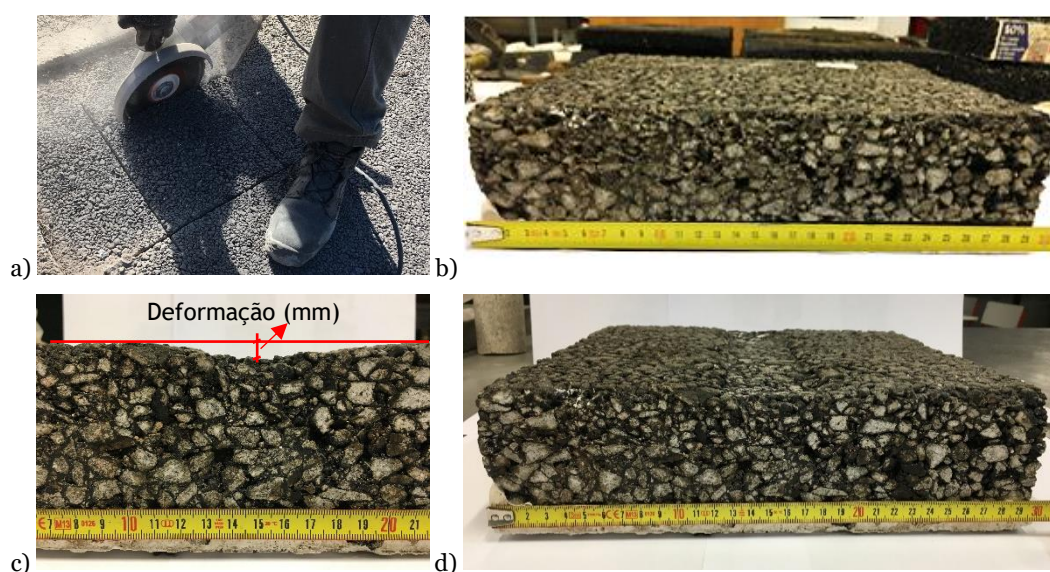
Lajeta extraída do pavimento (TE1) ensaiada no *Wheel tracking*: a) Corte do provete em campo; b) Antes da realização do ensaio; c) Pormenor após ensaio; d) Após realização do ensaio
